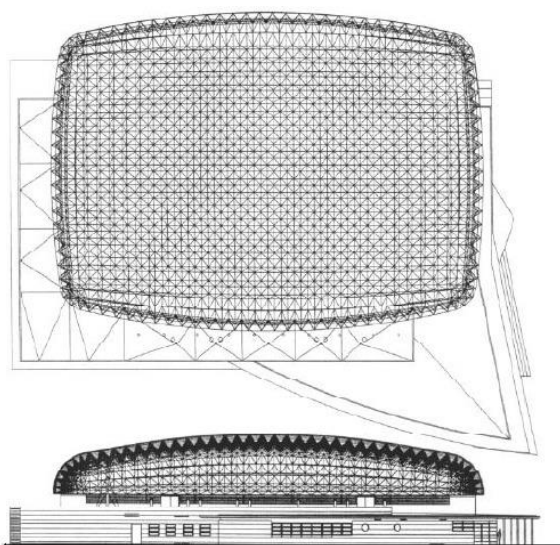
Planta e elevação do centro esportivo na Espanha (Cuenca, 2002)
